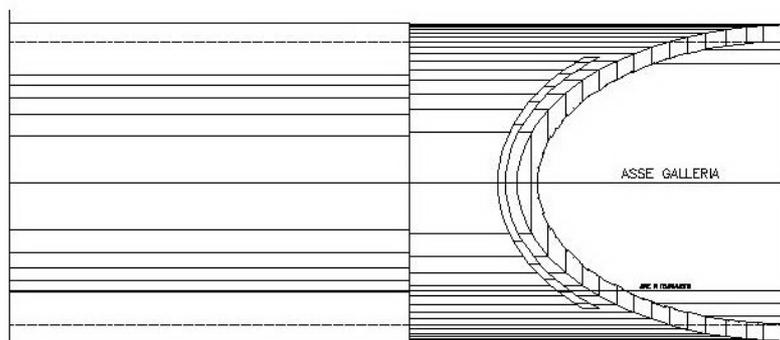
Concio terminale galleria artificiale a "becco di flauto"
